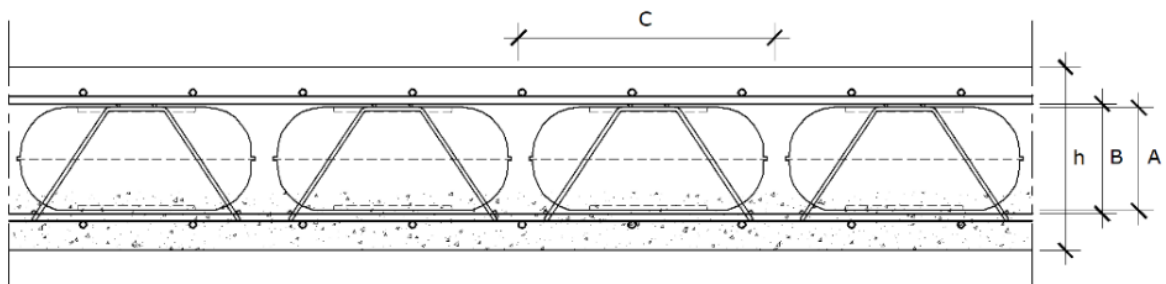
Secção tipo de uma laje com aligeiramento CBX da Ferca
